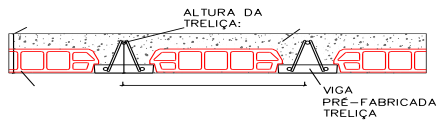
LAJE PRÉ-FABRICADA TRELIÇADA
